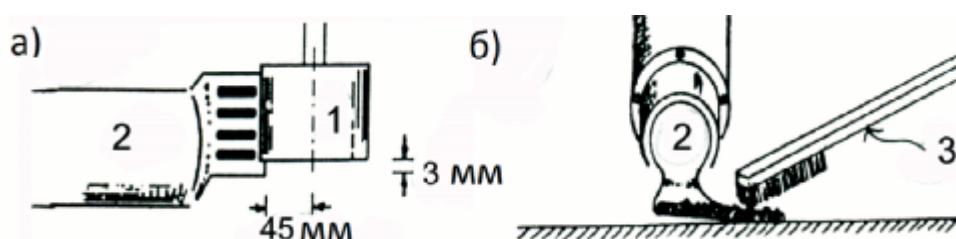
Расположение прикаточного ролика и очистка сопла.
